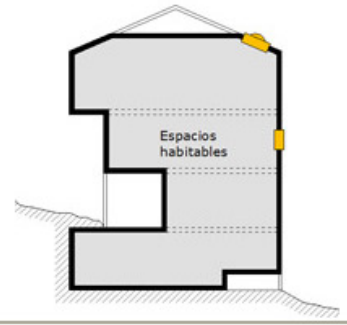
Carpintería exterior en Planta Baja. Fuente: propia
